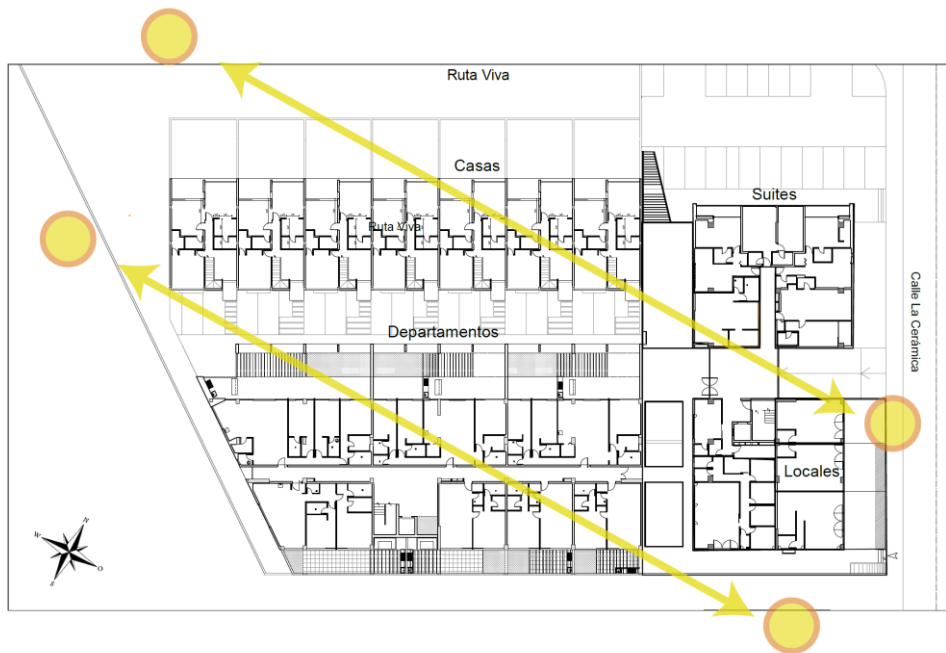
Trayecto del sol sobre planta arquitectónica del proyecto
